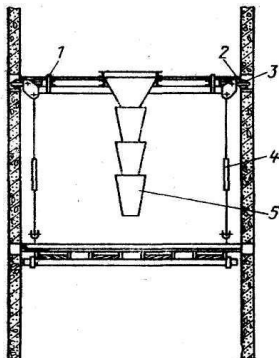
Подача бетонной смеси при бетонировании плит:
